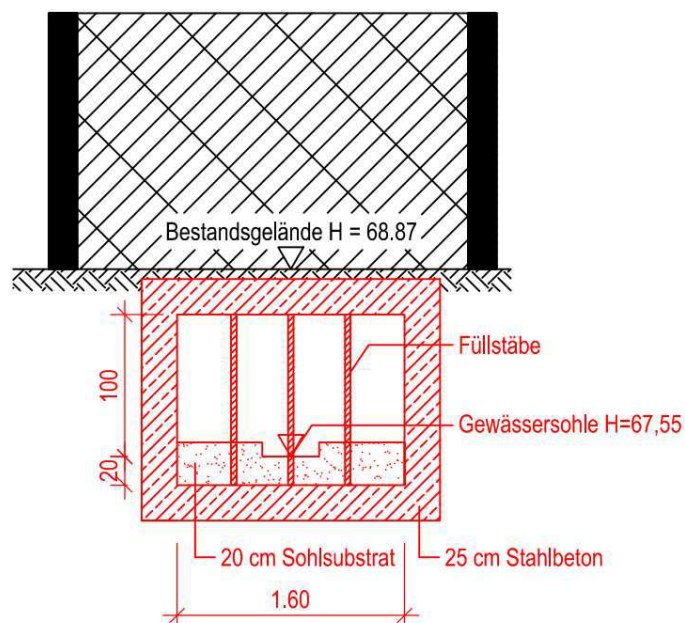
Querschnitt des Betonrahmens zur Führung des Unteren Bergwerkgrabens unter dem Zaun des Geländes der Wilhelm Heinrich Sobbe Stiftung
